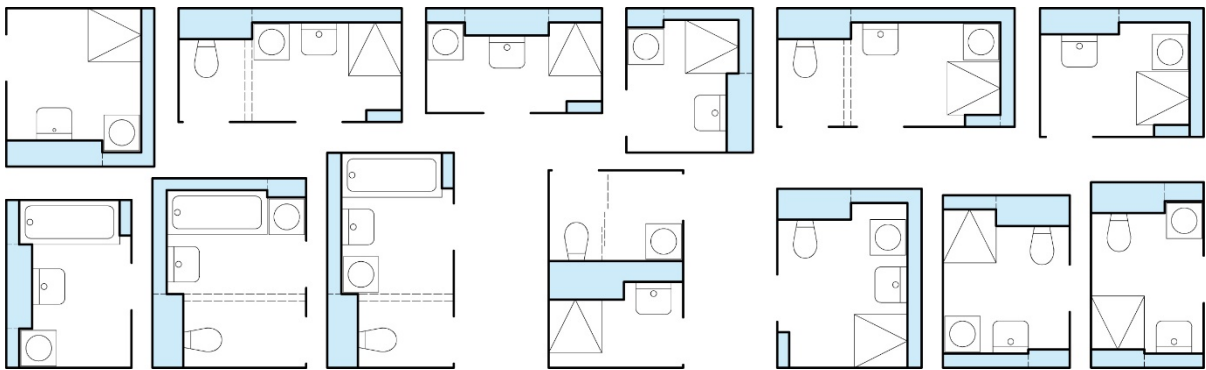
Häufige Badezimmertypen mit Installationsbereichen für eine holzbauadäquate Leitungsführung
